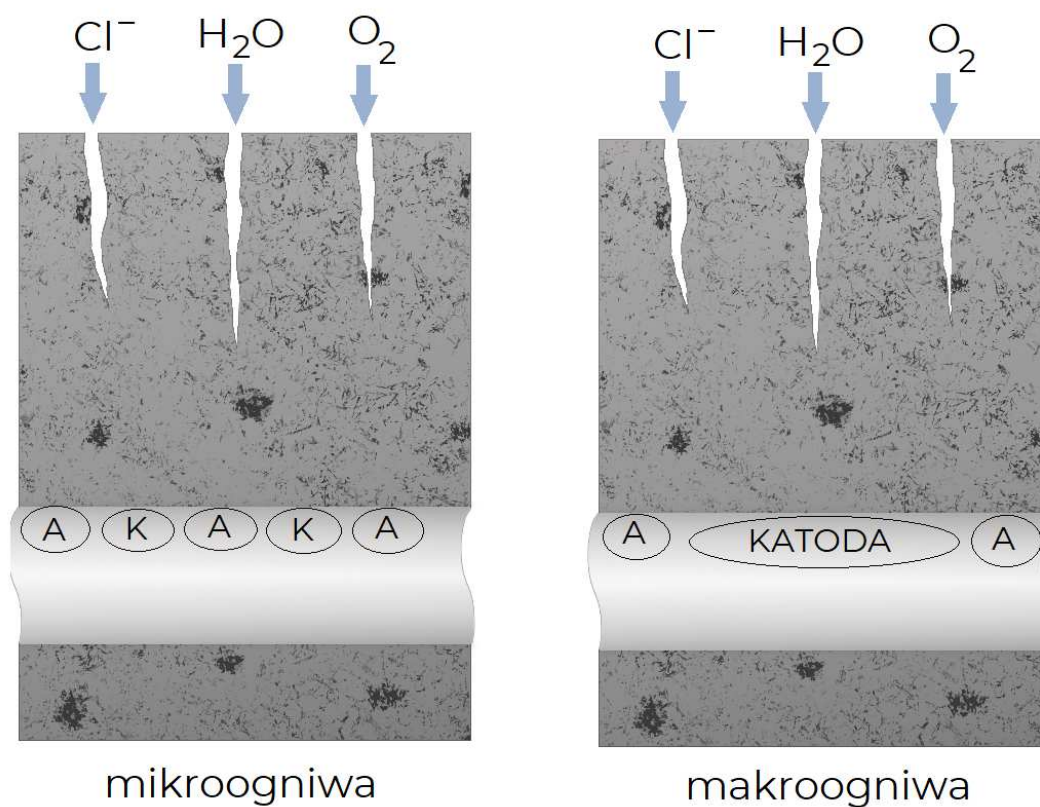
Korozja drutu zbrojeniowego w betonie.
